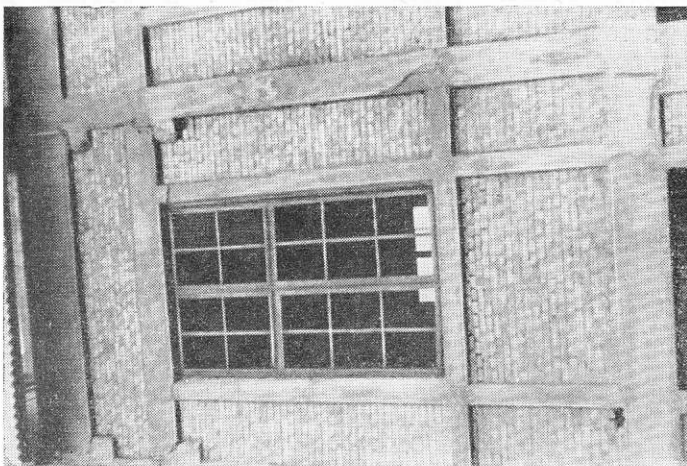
Фрагмент фасада помольного цеха и деталь железобетонного вкладыша
